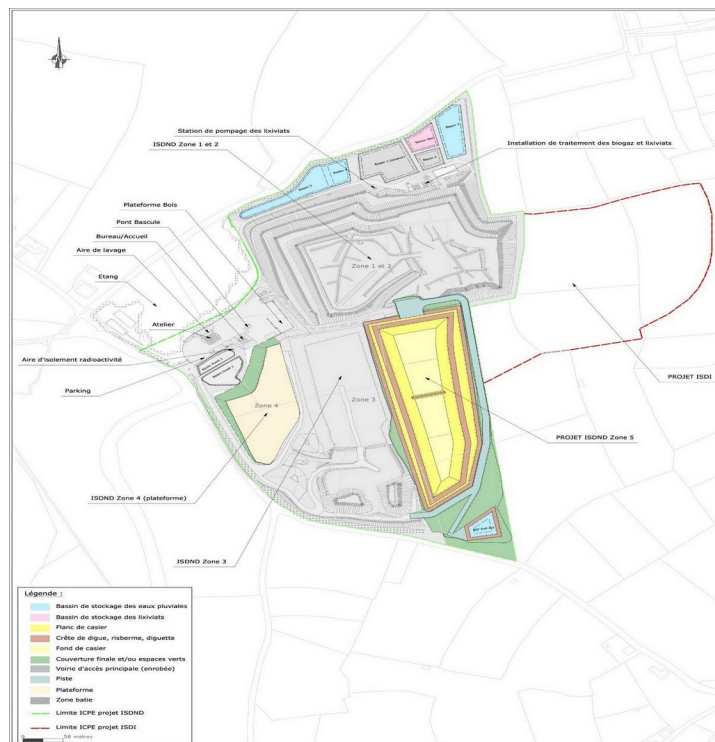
Plan général de l'installation projetée (Source : p. 40 de l'étude d'impact)
